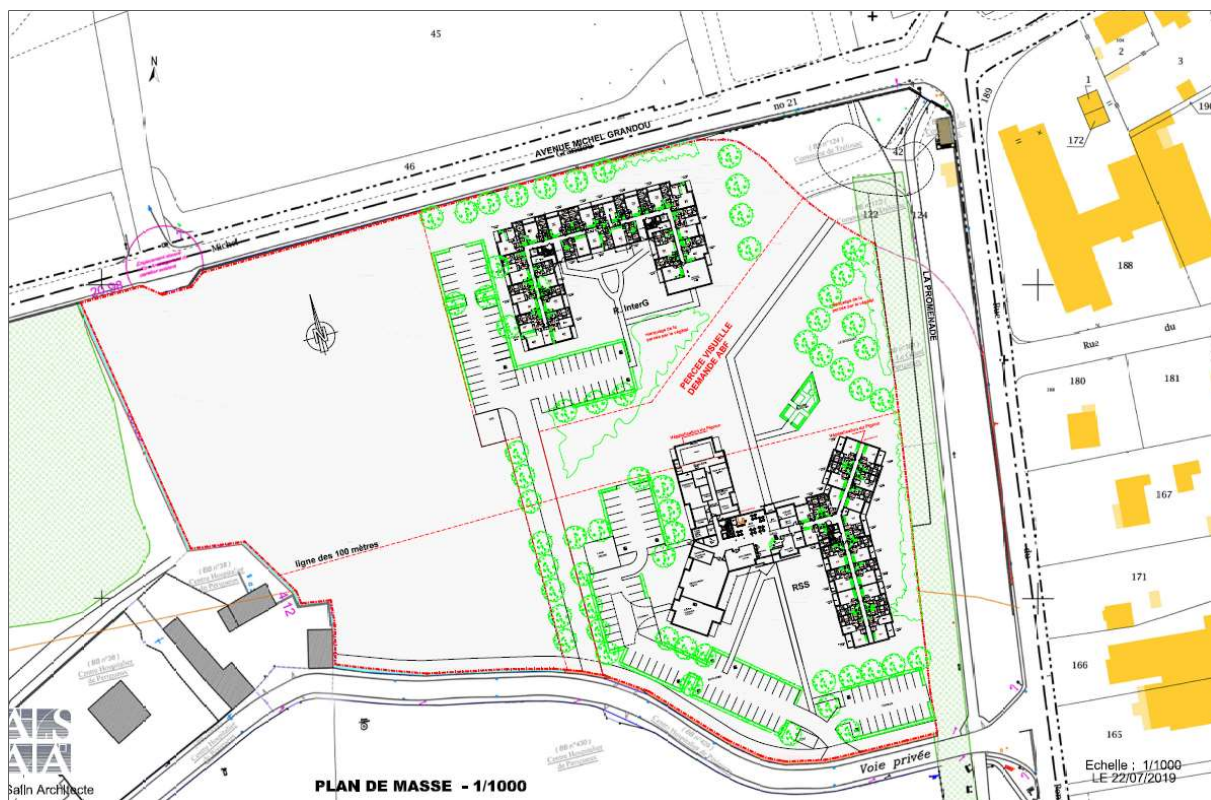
Plan masse du projet (Source : ASA Architecte ; juillet 2019)
